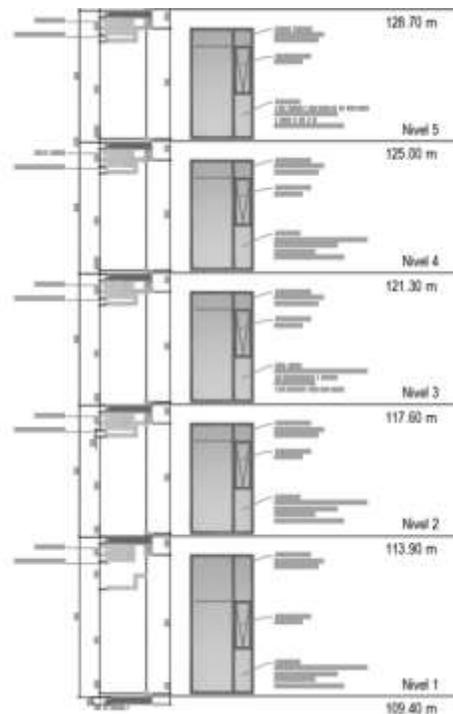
Detalle Ventanería Elevaciones Laterales
